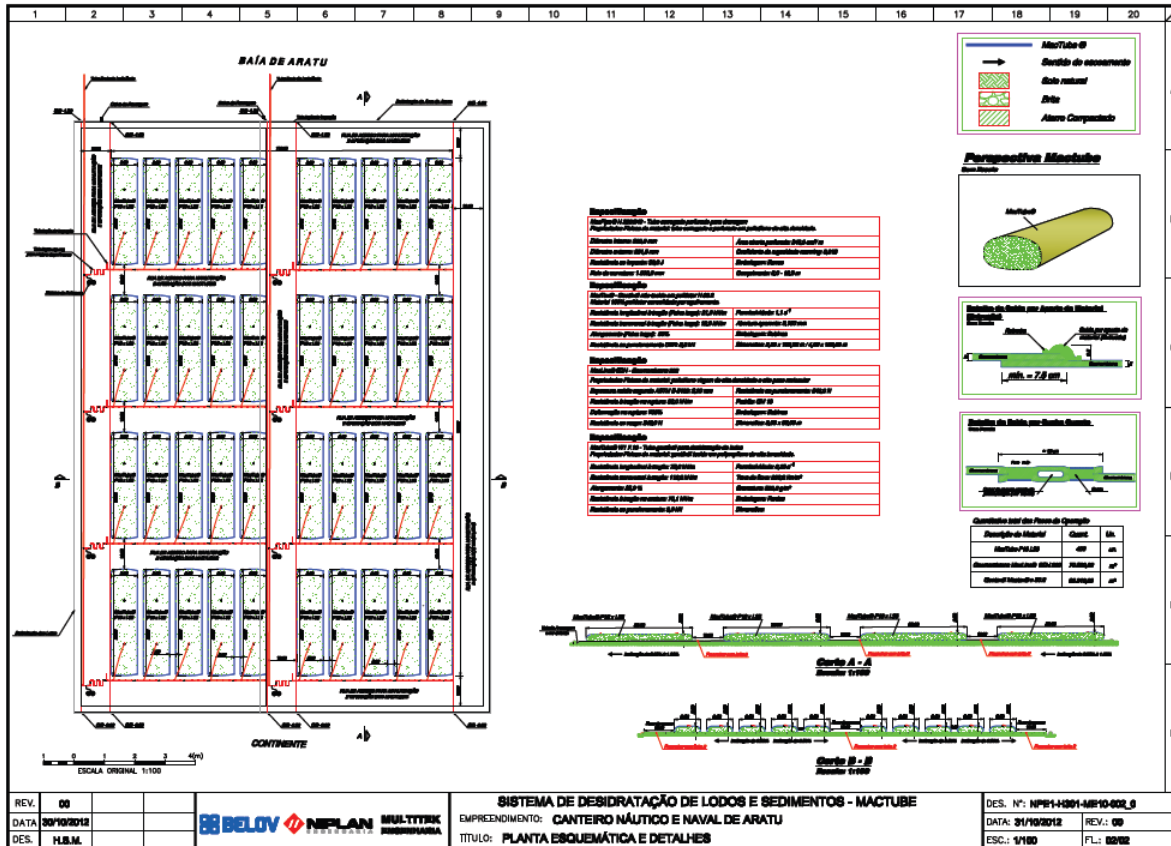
Planta esquemática de disposição de 40 módulos (Anexo 3.2)
